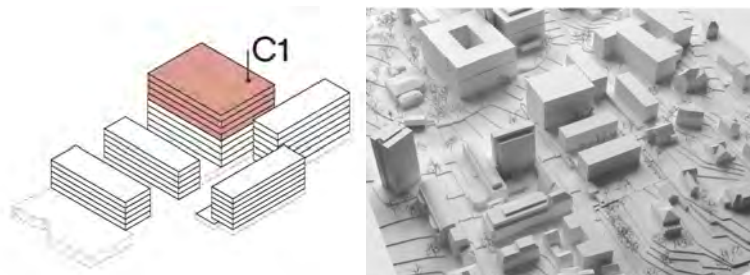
Aufstockung Hauptgebäude C1, Isometrie mit Darstellung der Geschosszahl
